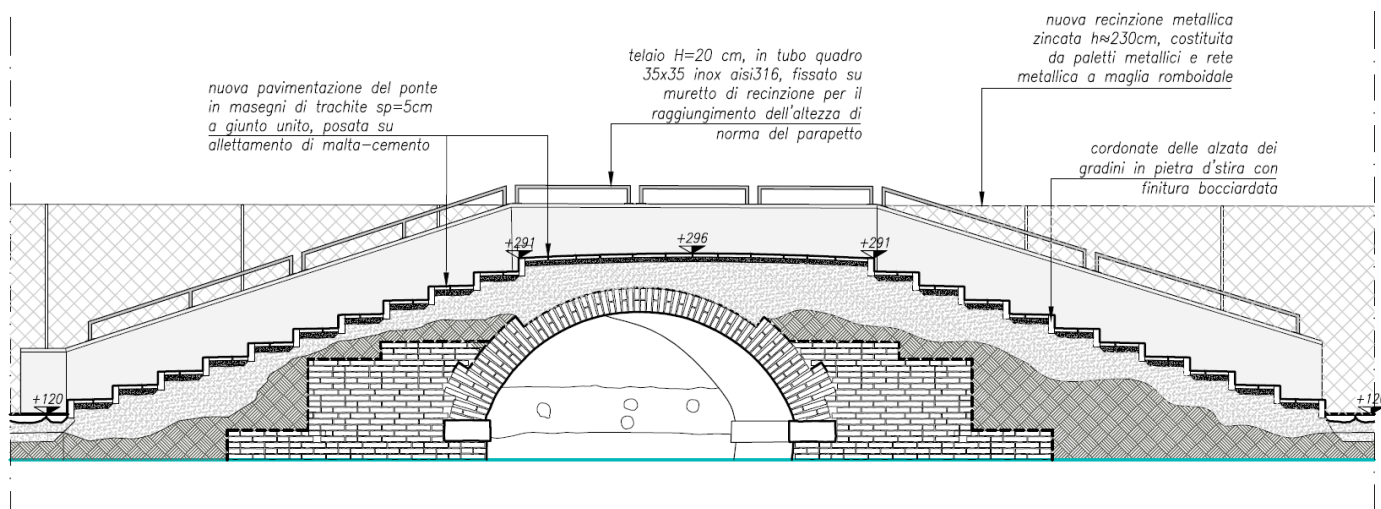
Sezione su Ponte della Cavana dell'Ospedale con vista verso la nuova recinzione metallica e telai metallici del parapetto del ponte – Tavola P.D.19
